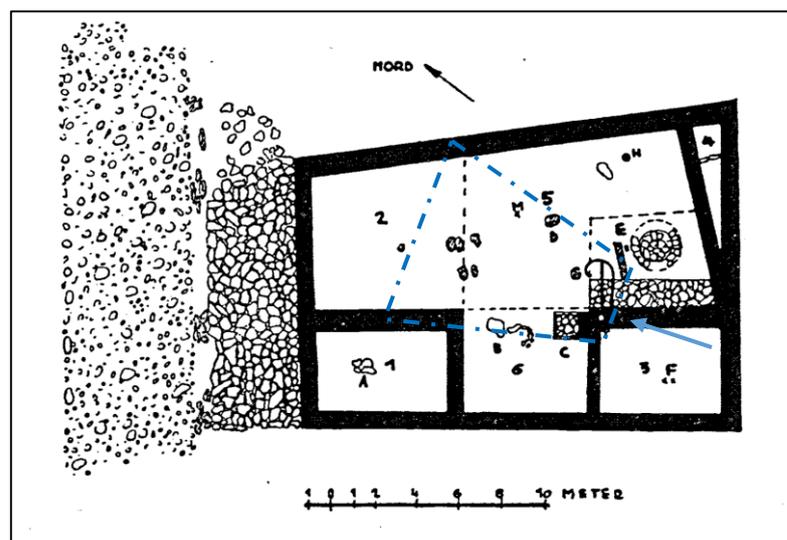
Grundriss eines römischen Gebäudes bei Wildbad Einöd
